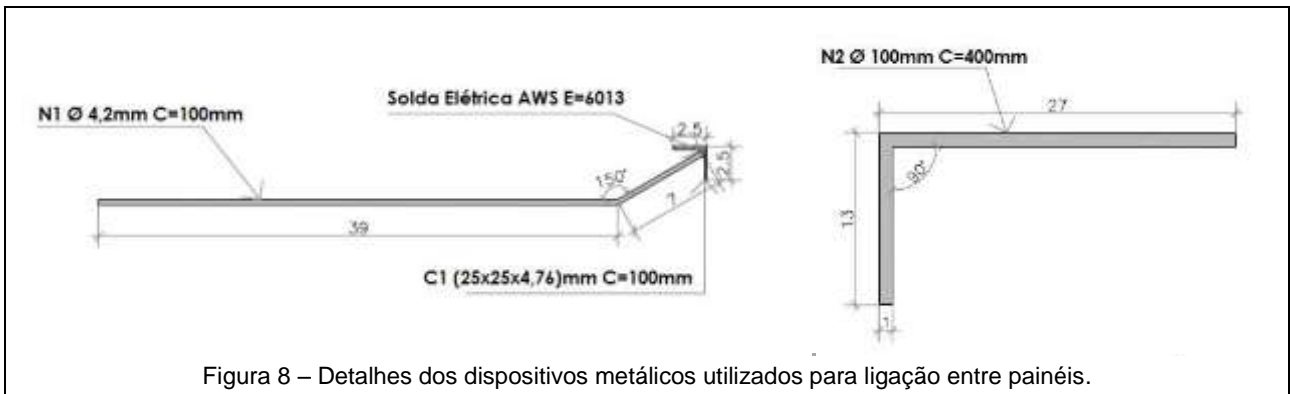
Detalhes dos dispositivos metálicos utilizados para ligação entre painéis.
